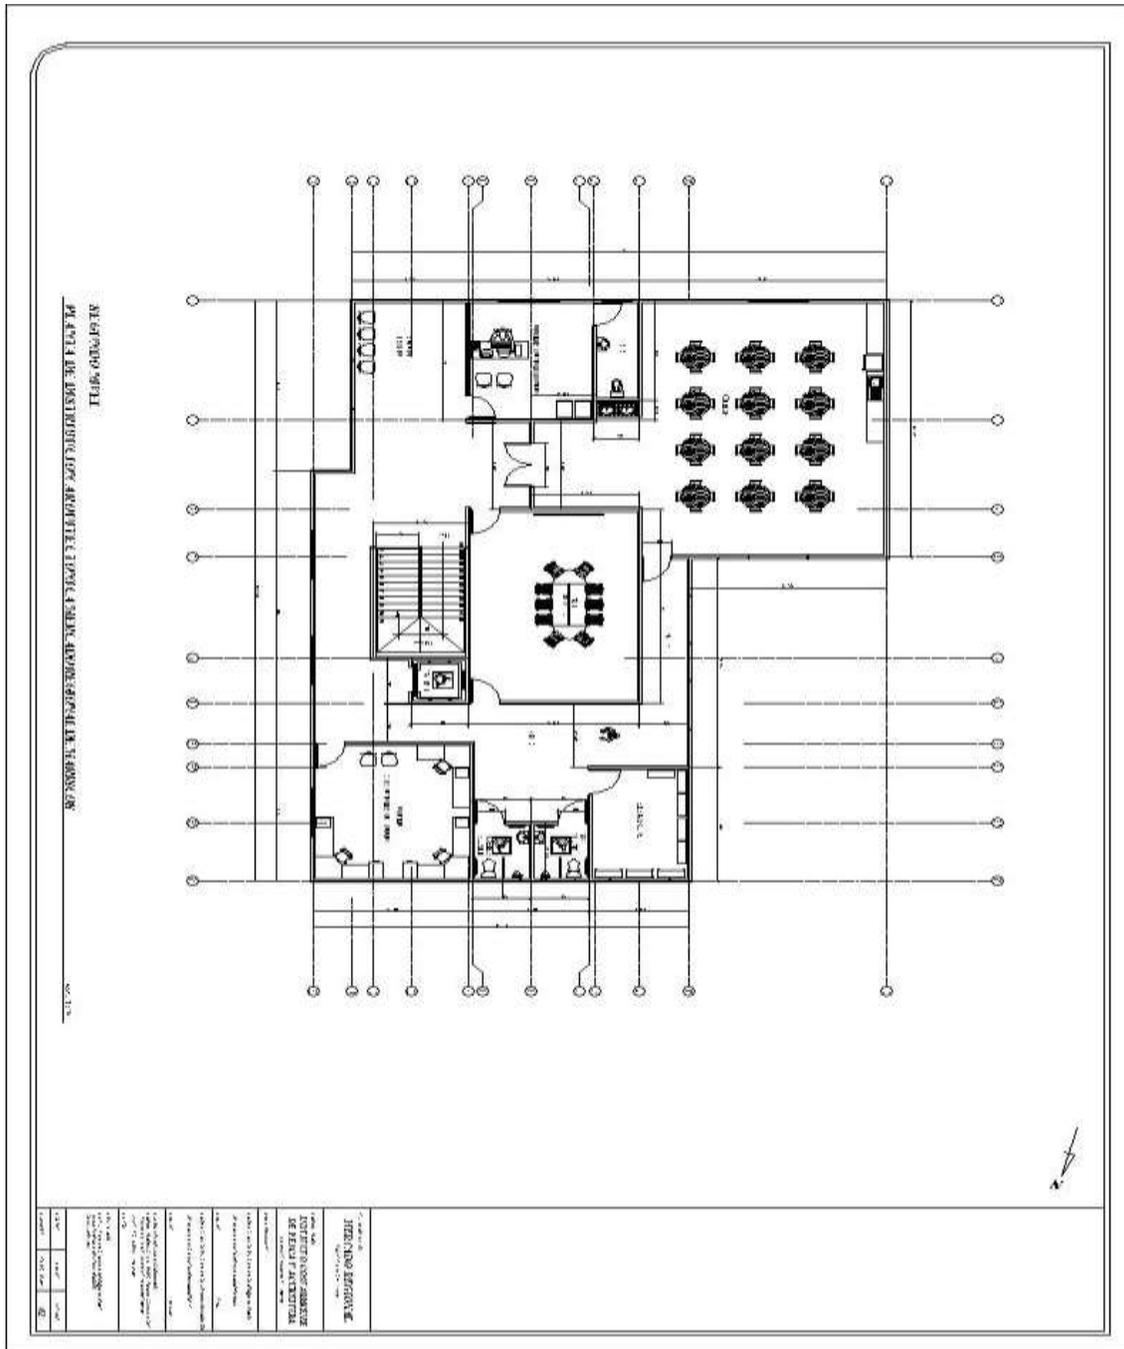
Segundo nivel, Planta de Distribución Arquitectónica Mercado
